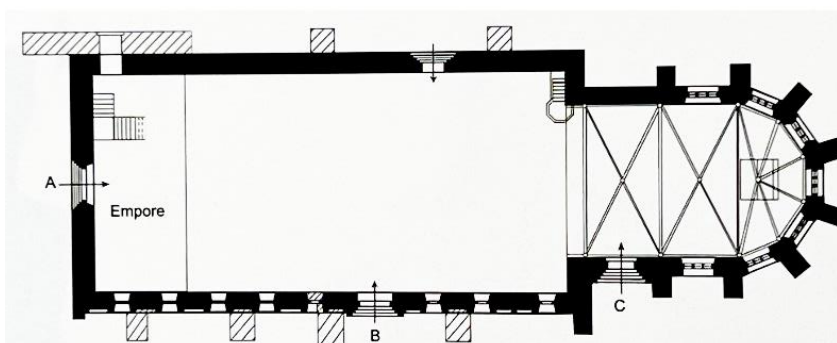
Grundriss der Klosterkirche (nach Eichholz/Solger/Spatz 1907).
